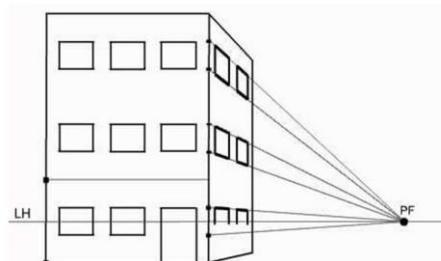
Desenho Técnico – Perspectiva cônica com um ponto de fuga.
